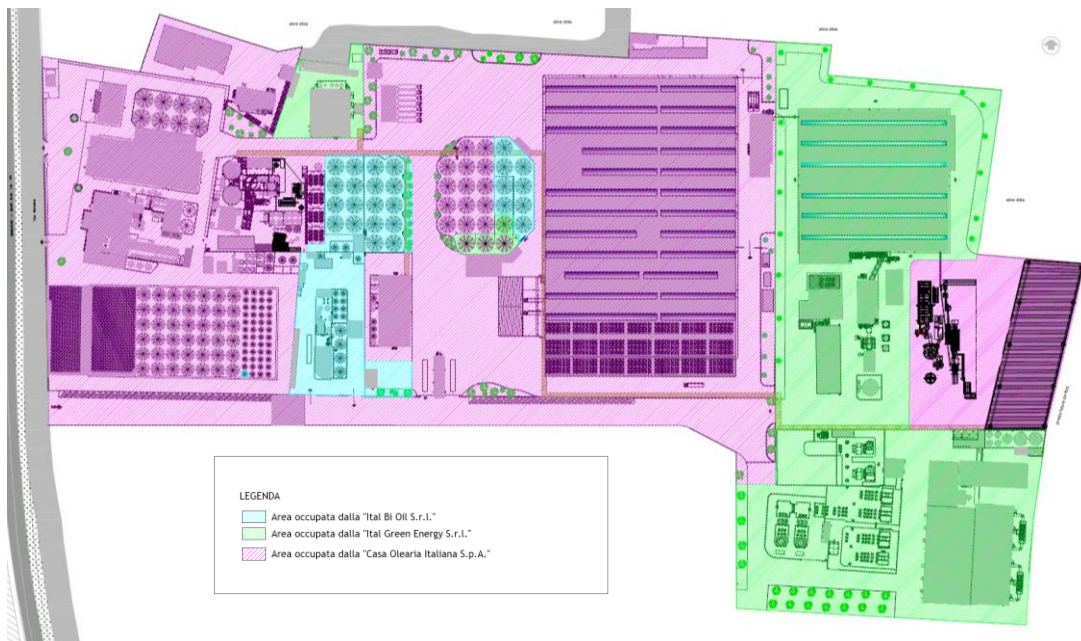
Planimetria impianti del gruppo industriale Marseglia
